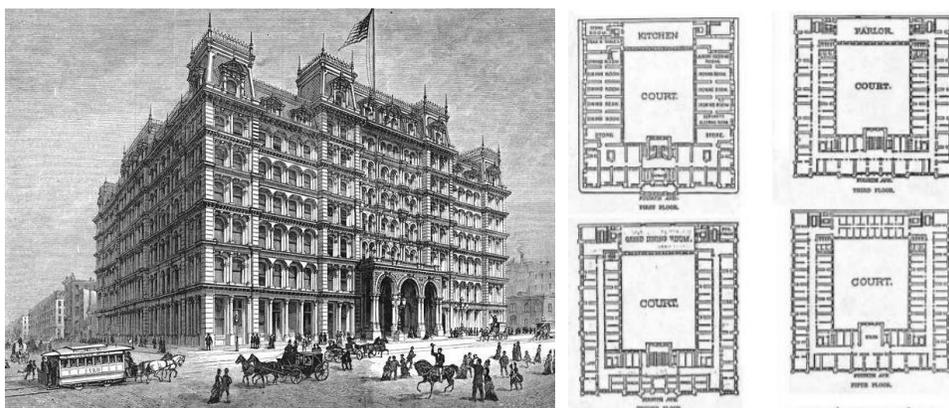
Working Women's hotel 1878. Fuente: *The Grand Domestic Revolution*. Hayden, 1981
